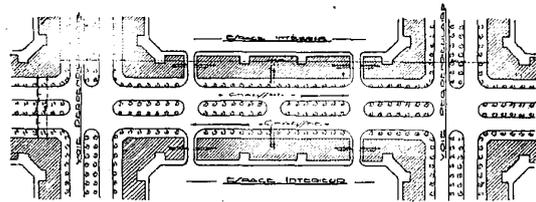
Plan d'une voie de largeur : 40 mètres
